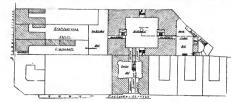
Lageplan der Garage der Kraftfahrzeug-A.-G.
